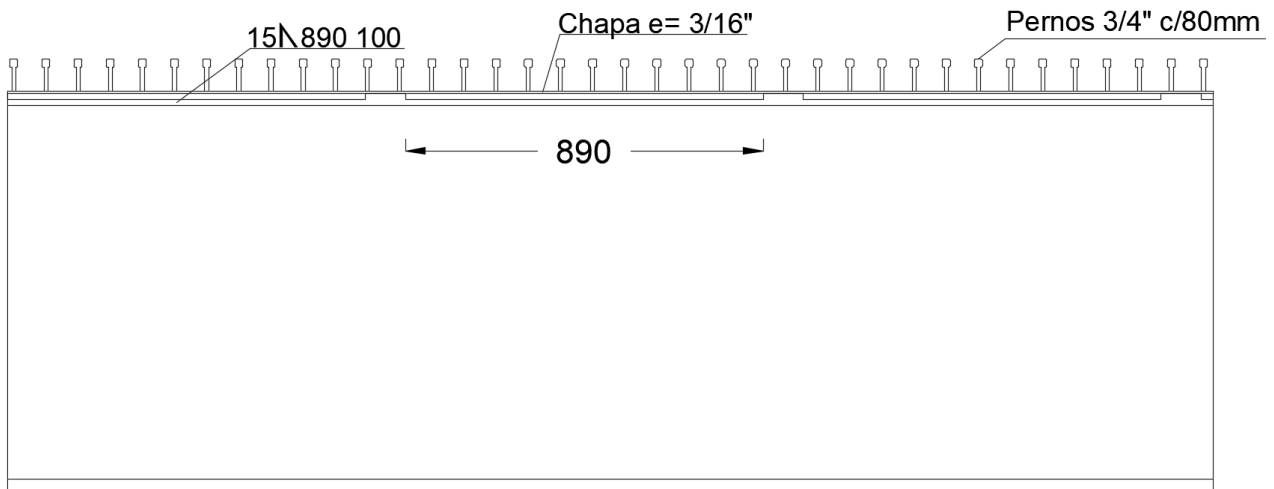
Vista lateral de la viga longitudinal externa con la placa para conexión con el tablero en el ala superior.
